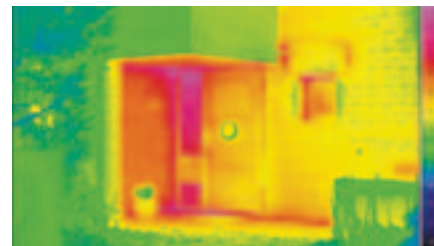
Wärmebrücke im Bereich einer Hauseingangstür
